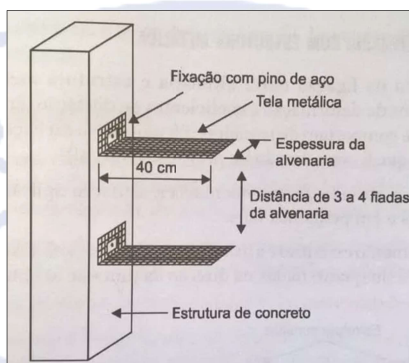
Distribuição de telas de aço galvanizado para amarração de alvenaria
